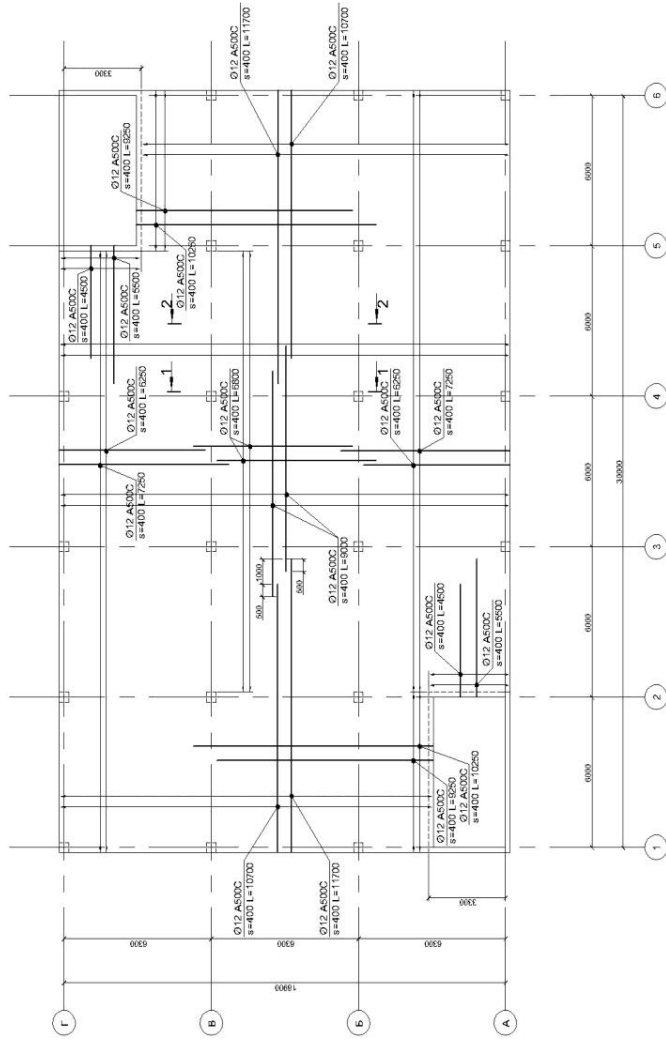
Схема нижнего армирования плиты перекрытия отдельными стержнями
